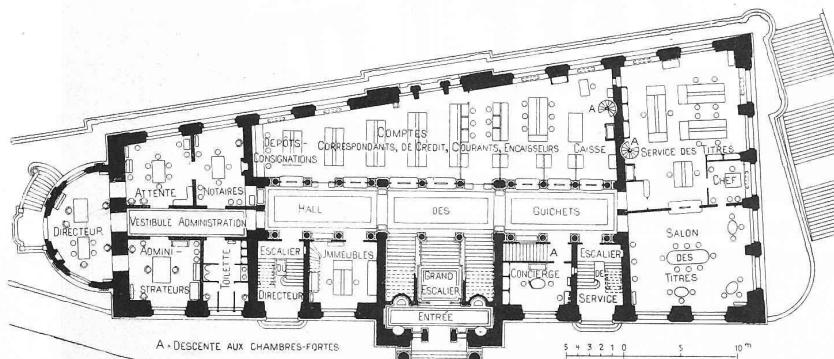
Plan du rez-de-chaussée. — Echelle 1 : 600.
